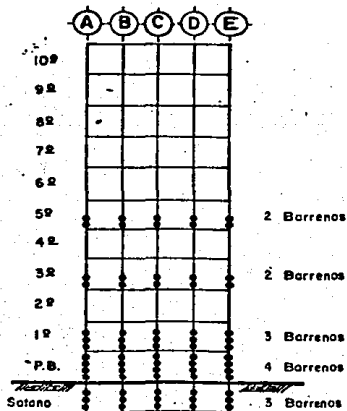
Número de niveles a preparar y cantidad de barrenos en cada columna.
